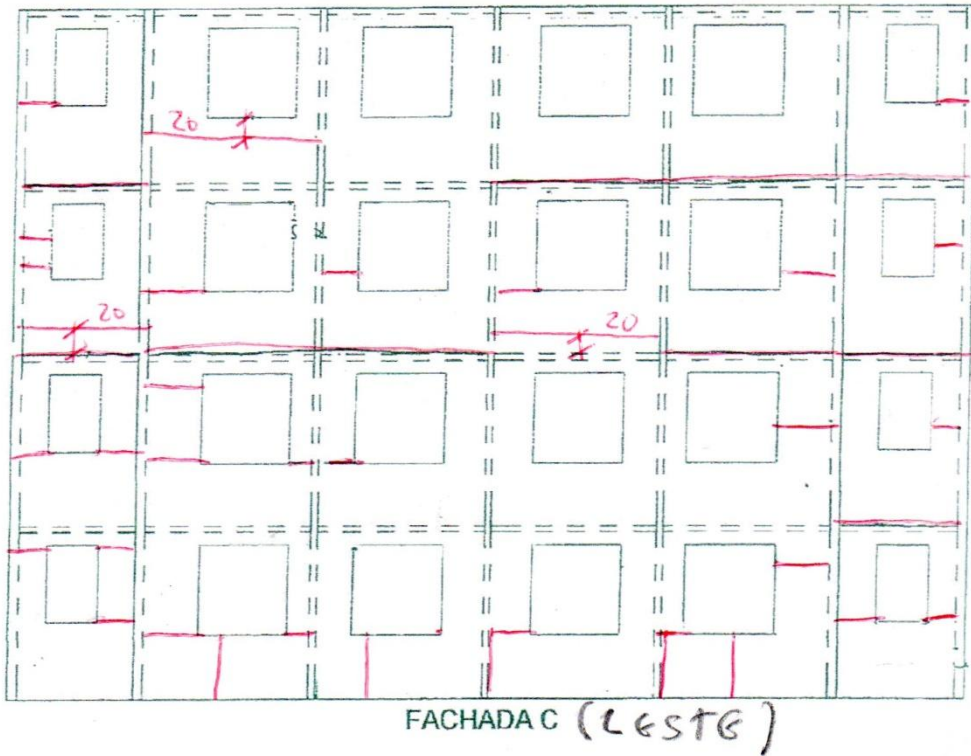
Mapa de Fissuras (próprios autores).
